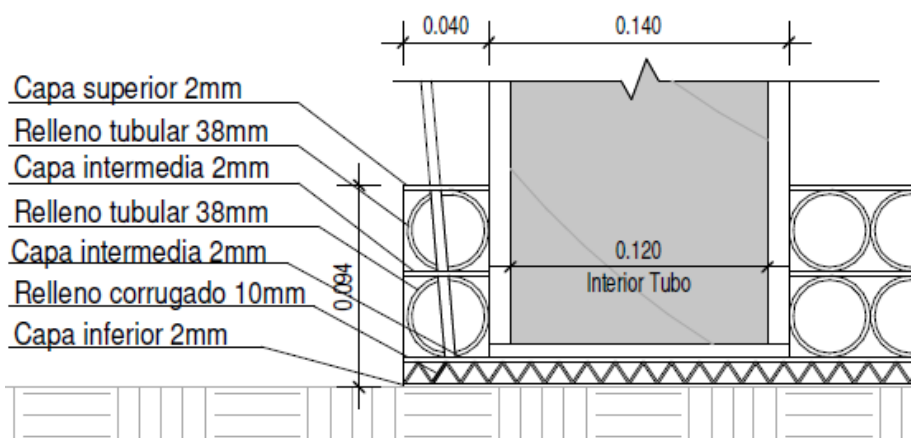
Detalle del encaje del conjunto de tubos con la placa del piso. Fuente: Desarrollado por el autor
